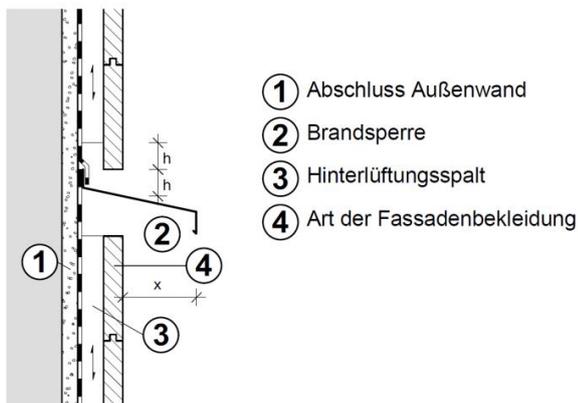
Schematischer Aufbau einer hinterlüfteten Holzfassade (aus dem Englischen nach „Structural Means for Fire-Safe Wooden Façade Design“)
